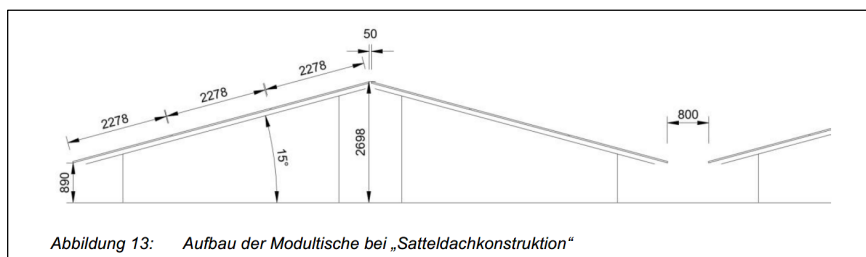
Aufbau der Modultische bei „Satteldachkonstruktion“
